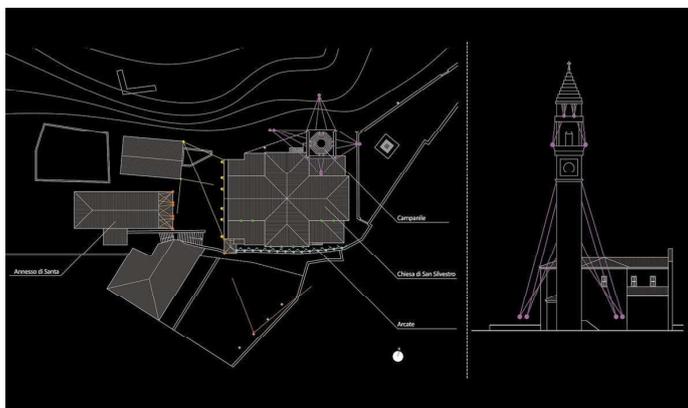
Planimetria posizionamento apparecchi con dettaglio prospettico del campanile.
